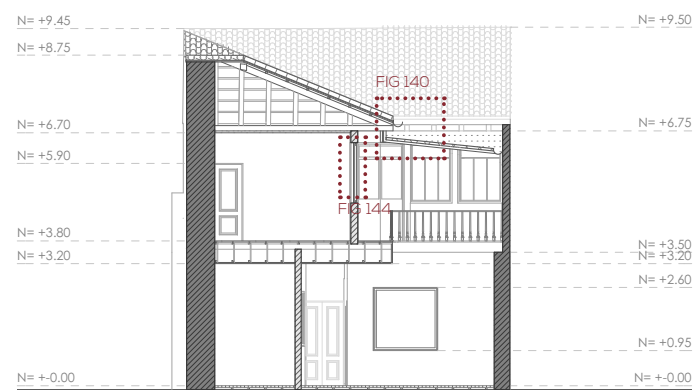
Sección transversal C -C | Caso de estudio 2, Vivienda Berrezueta.
